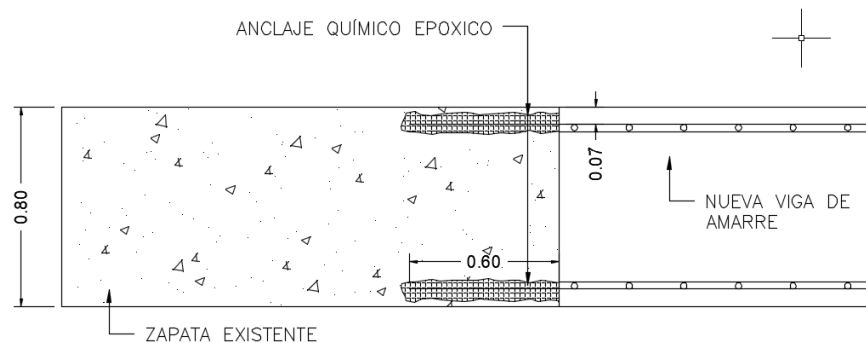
Detalle conexión vigas de cimentación con las zapatas existentes. Profundidad de penetración anclajes. Fuente: Autores.
